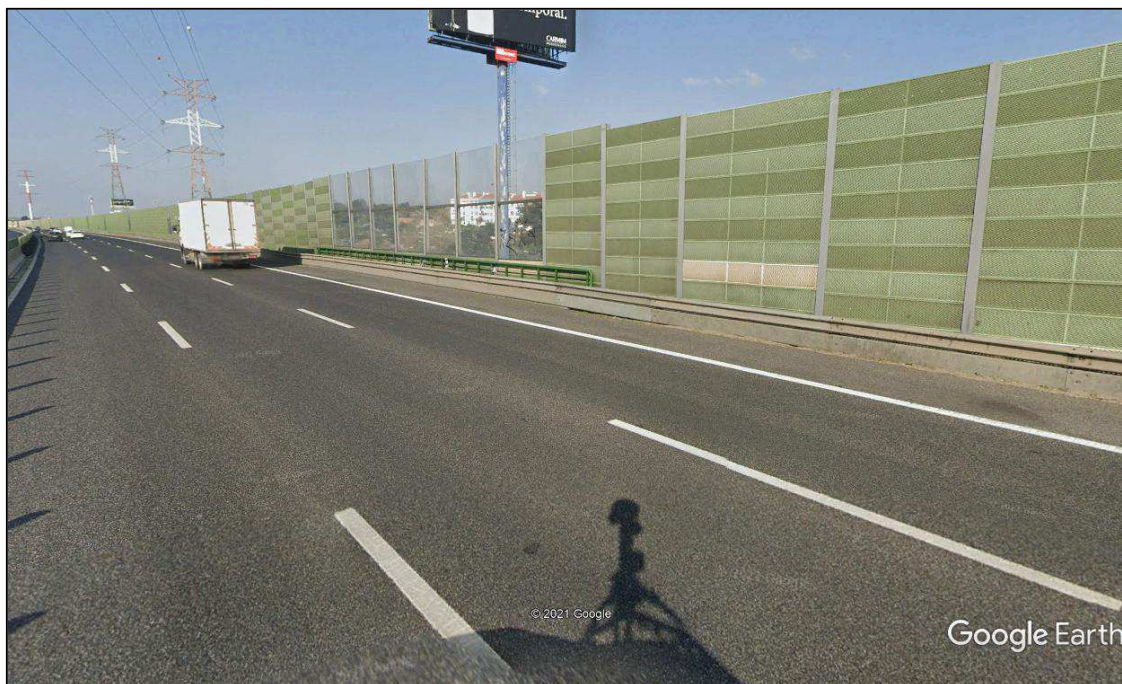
Exemplos de barreiras acústicas instaladas na A1
